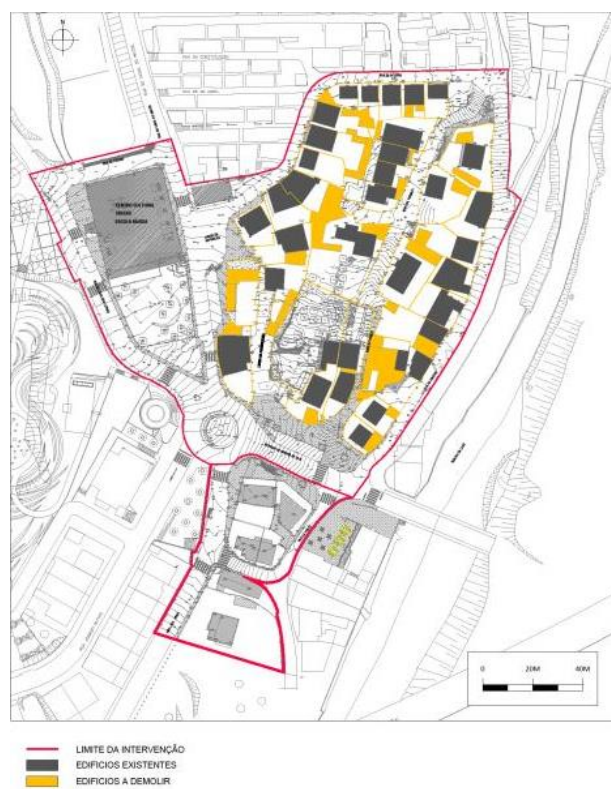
Planta da zona A do bairro da Laje com existente e demolições. Fonte: CMO/DPE
